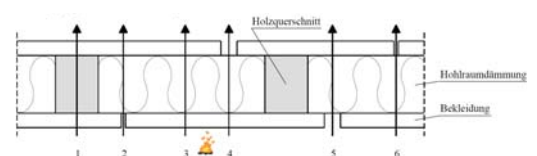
Mögliche Wärmedurchgänge durch das Bauteil
